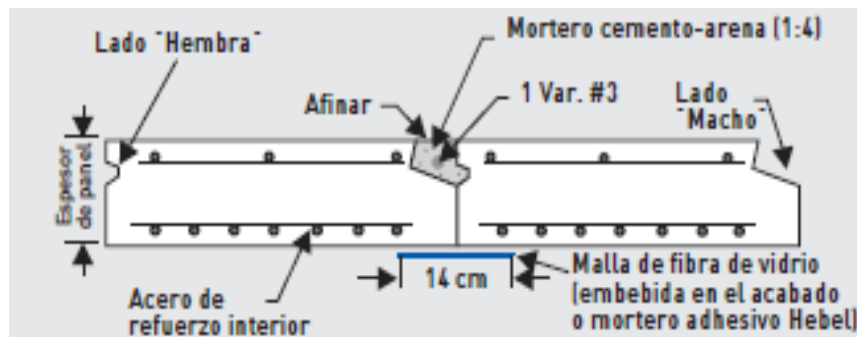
Corte del panel losa mostrando la aplicación del mortero entre juntas
